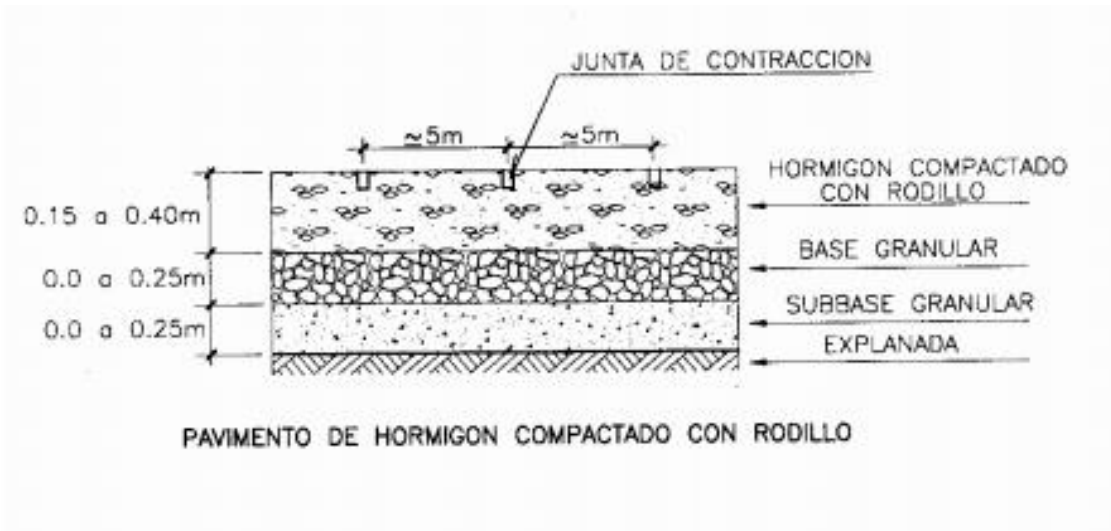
Pavimento definitivo para la zona complementaria de estacionamiento.
